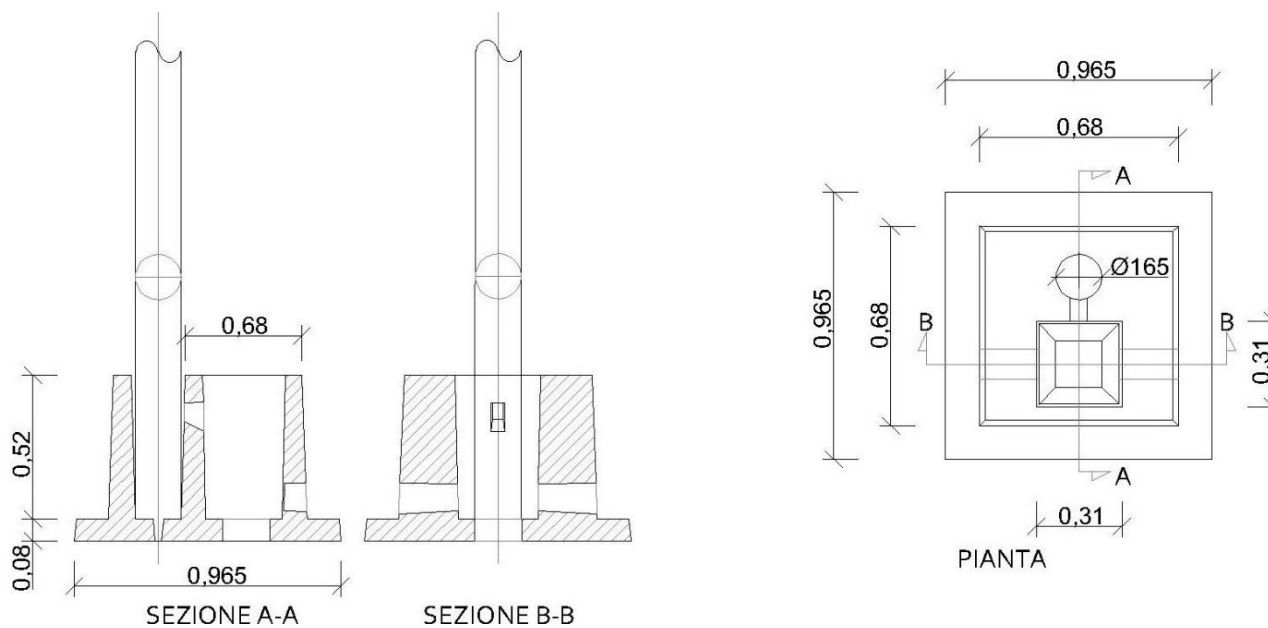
Sezioni e piante della fondazione del palo di illuminazione e videosorveglianza
